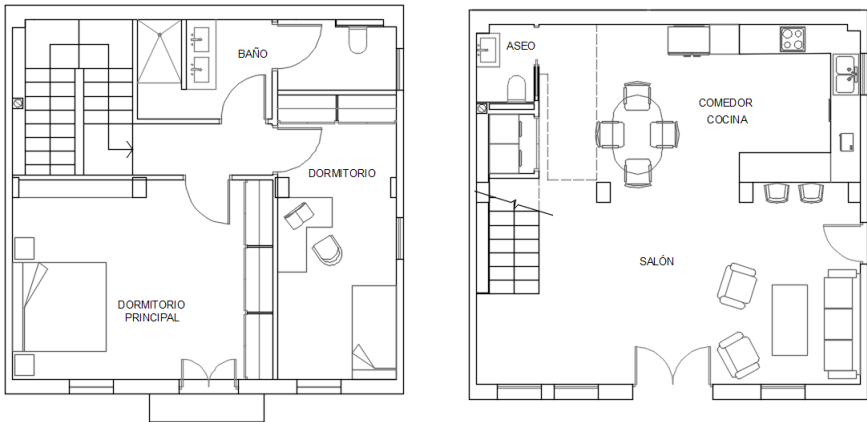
Distribución vivienda. Planta baja y planta primera Alquería. Autor propio
